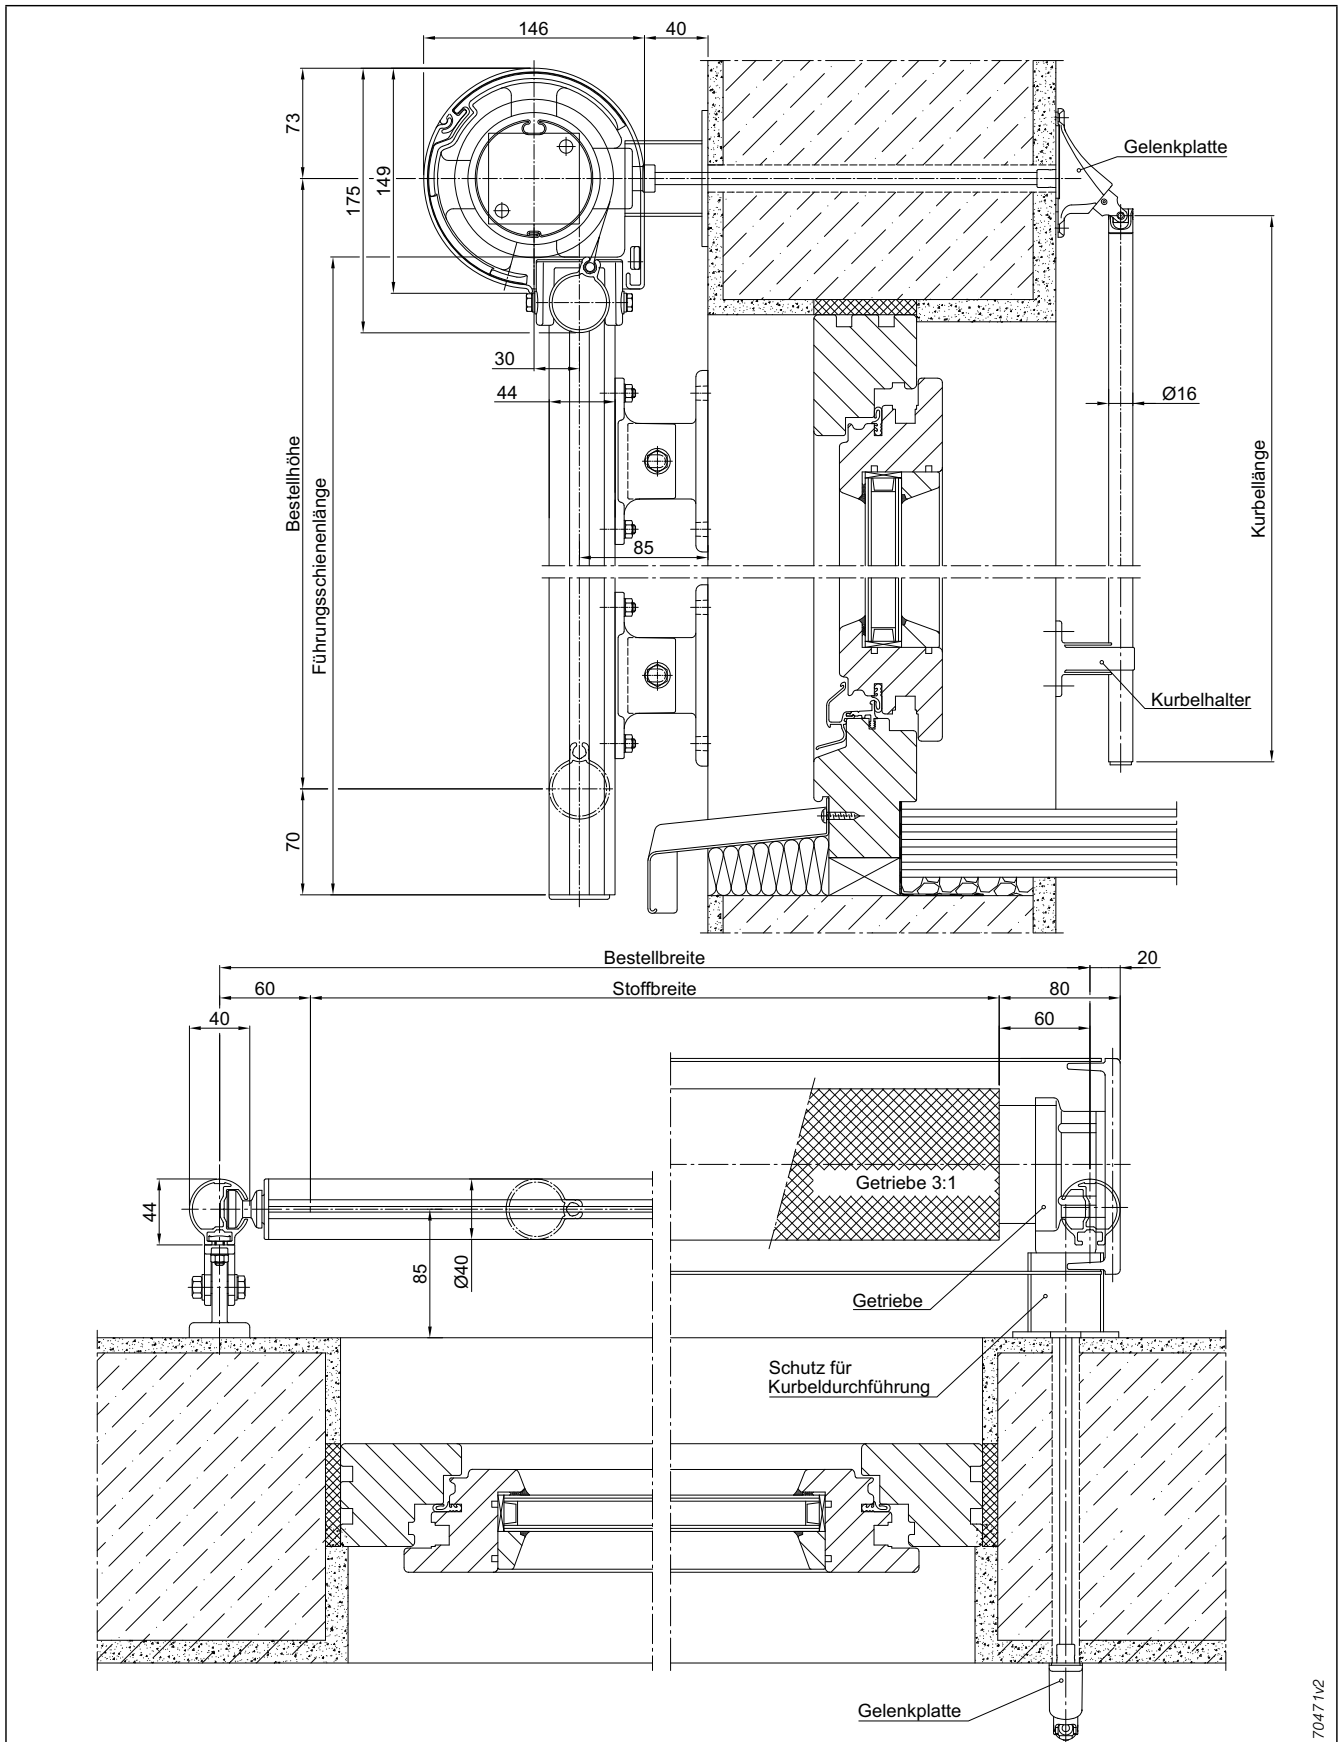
Fassaden-Markise 201 mit Rundblende Typ 8.3, Kurbelantrieb
